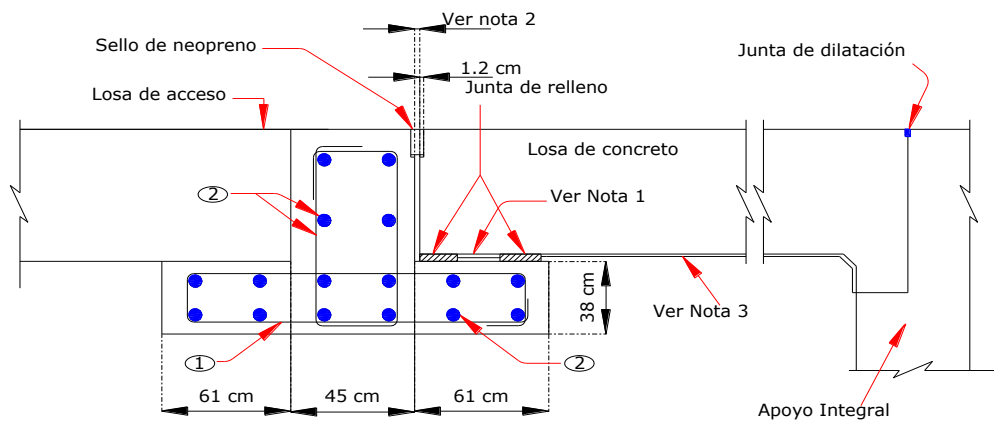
Corte A-A, de la Fig. 20 de la plantilla de losa (opcional)
